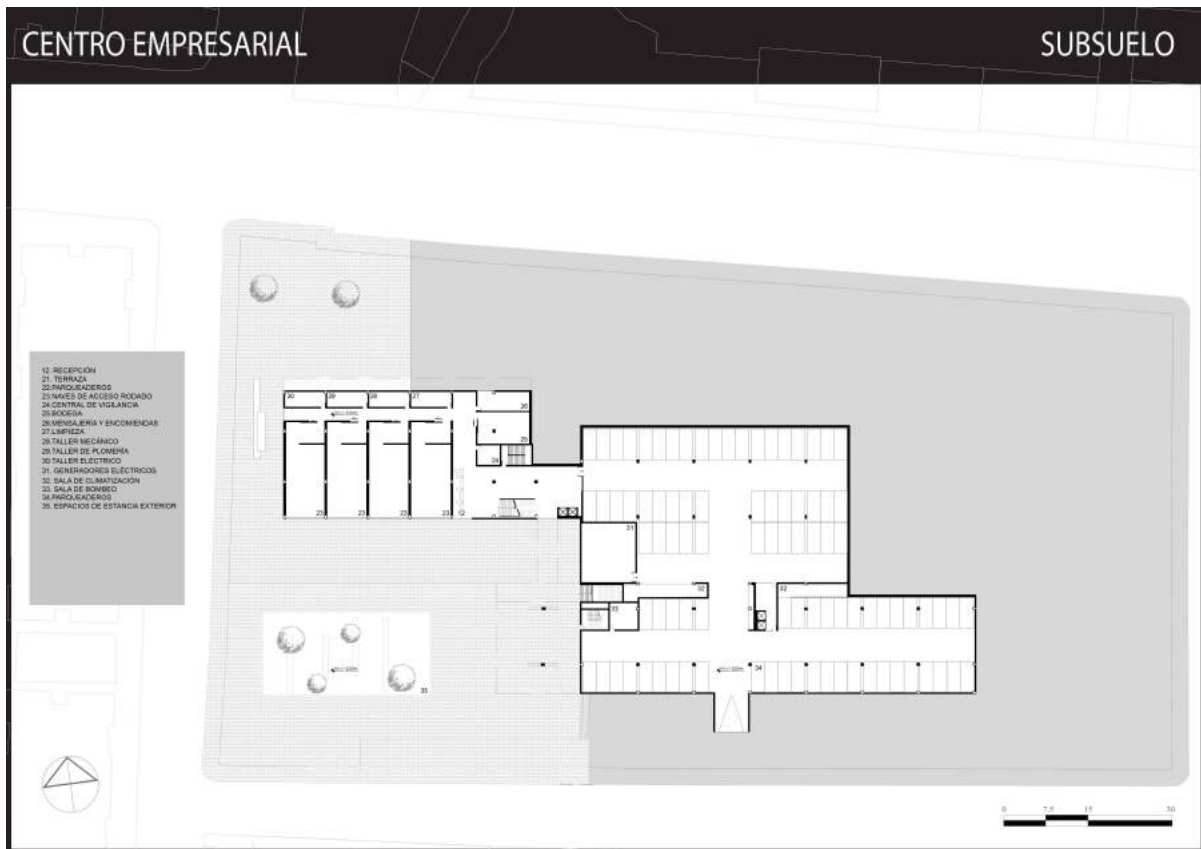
Planta subsuelo y parqueaderos. Elaboración propia.
